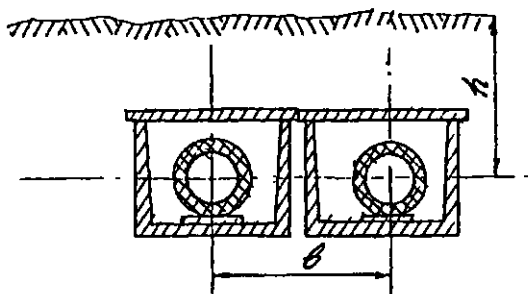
Пример прокладки каждого теплопровода в отдельном канале
